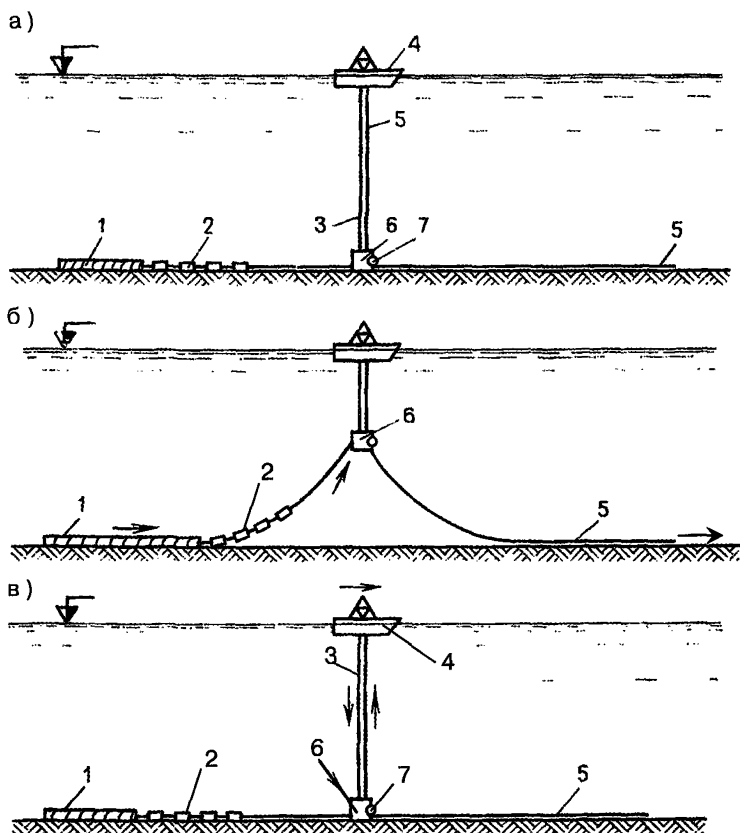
Схема протаскивания трубопровода с подъемом донного груза:
